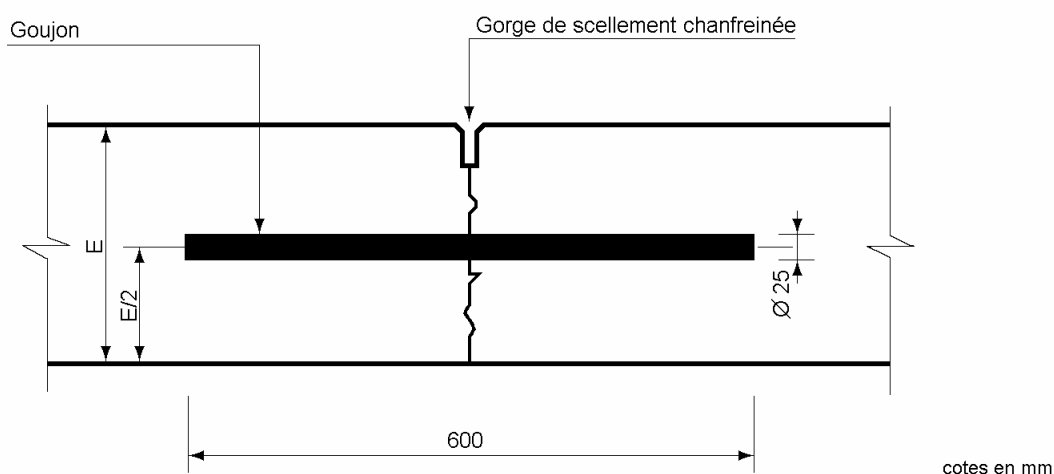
Joint transversal de construction
